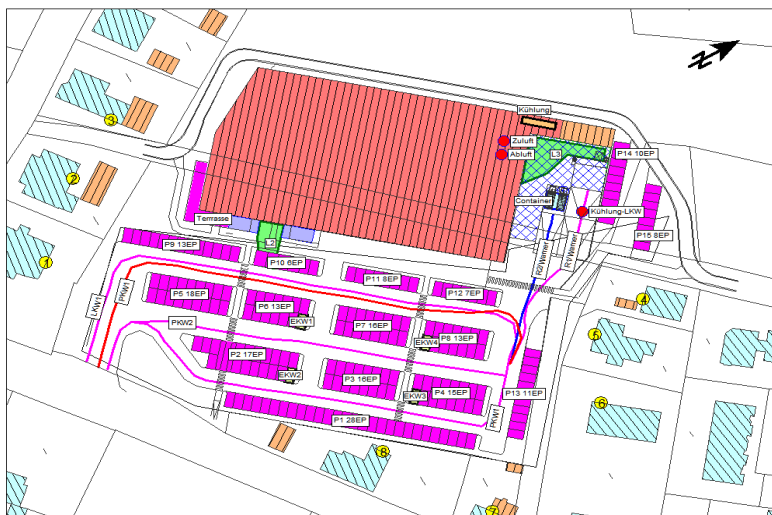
Lageplan zum Bauvorhaben (Architekten Diekmann)
